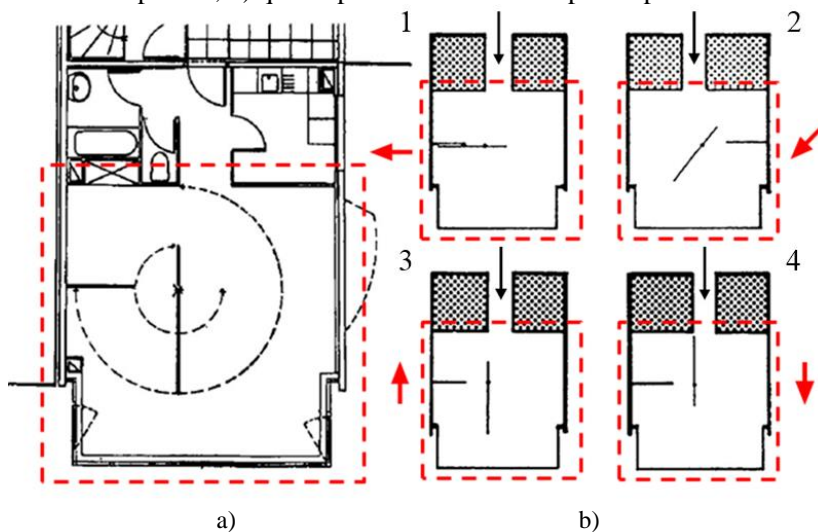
Exemplo de diversidade tipológica: a) planta baixa do pavimento tipo 1; b) planta baixa do pavimento tipo 2.
